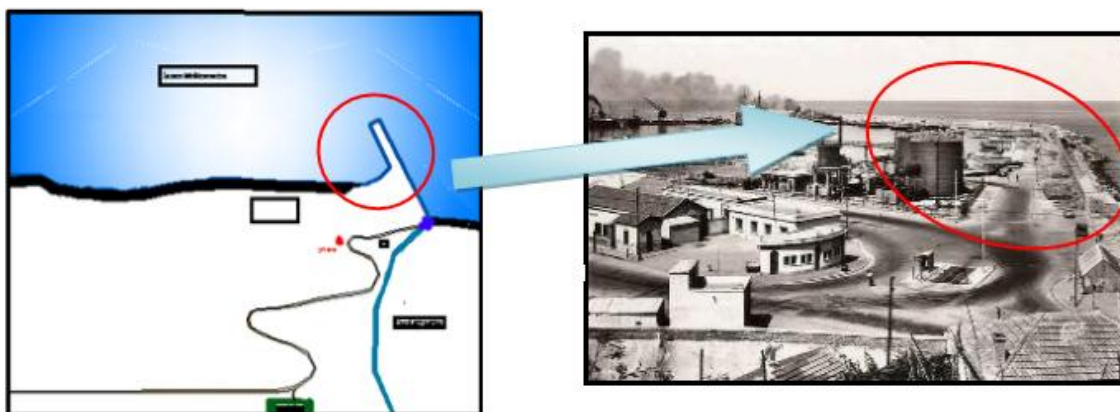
plan schématisant la construction de la 1 ère jetée vers 1840 ; source l'auteur 2017
